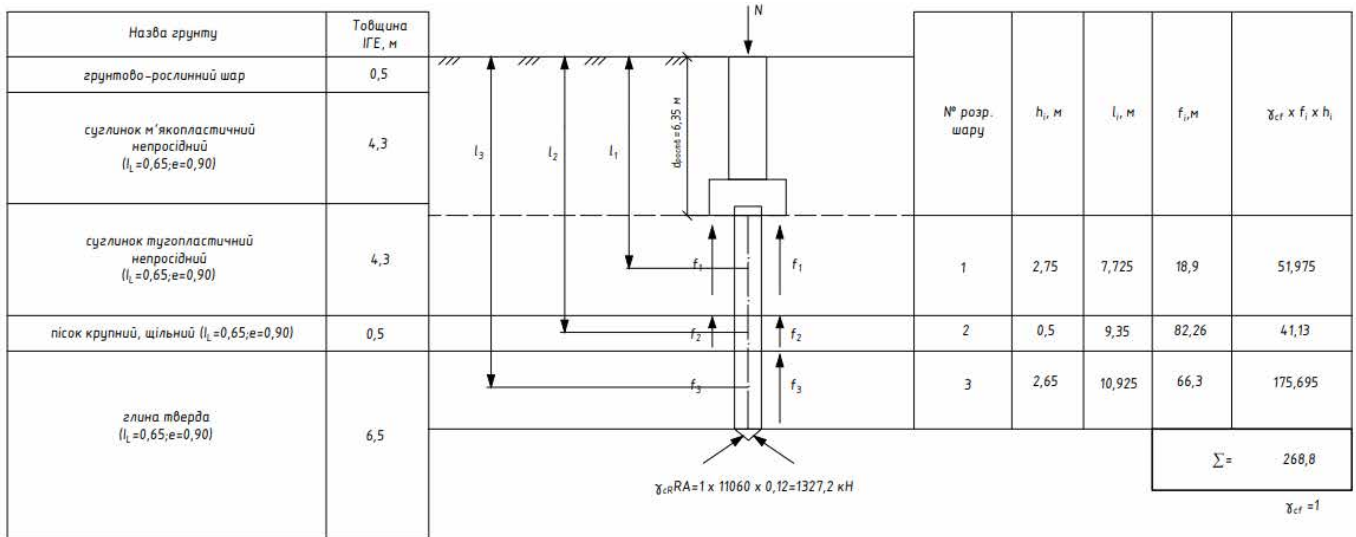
Схема до розрахунку несучої здатності палі фундаменту під зовнішню стіну по осі 1
